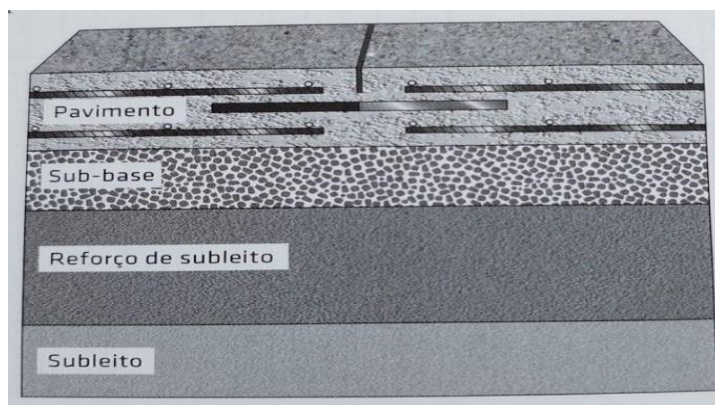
Camadas constituintes do pavimento rígido de concreto armado (Fonte: Pavimentos industriais em concreto, 2023).
